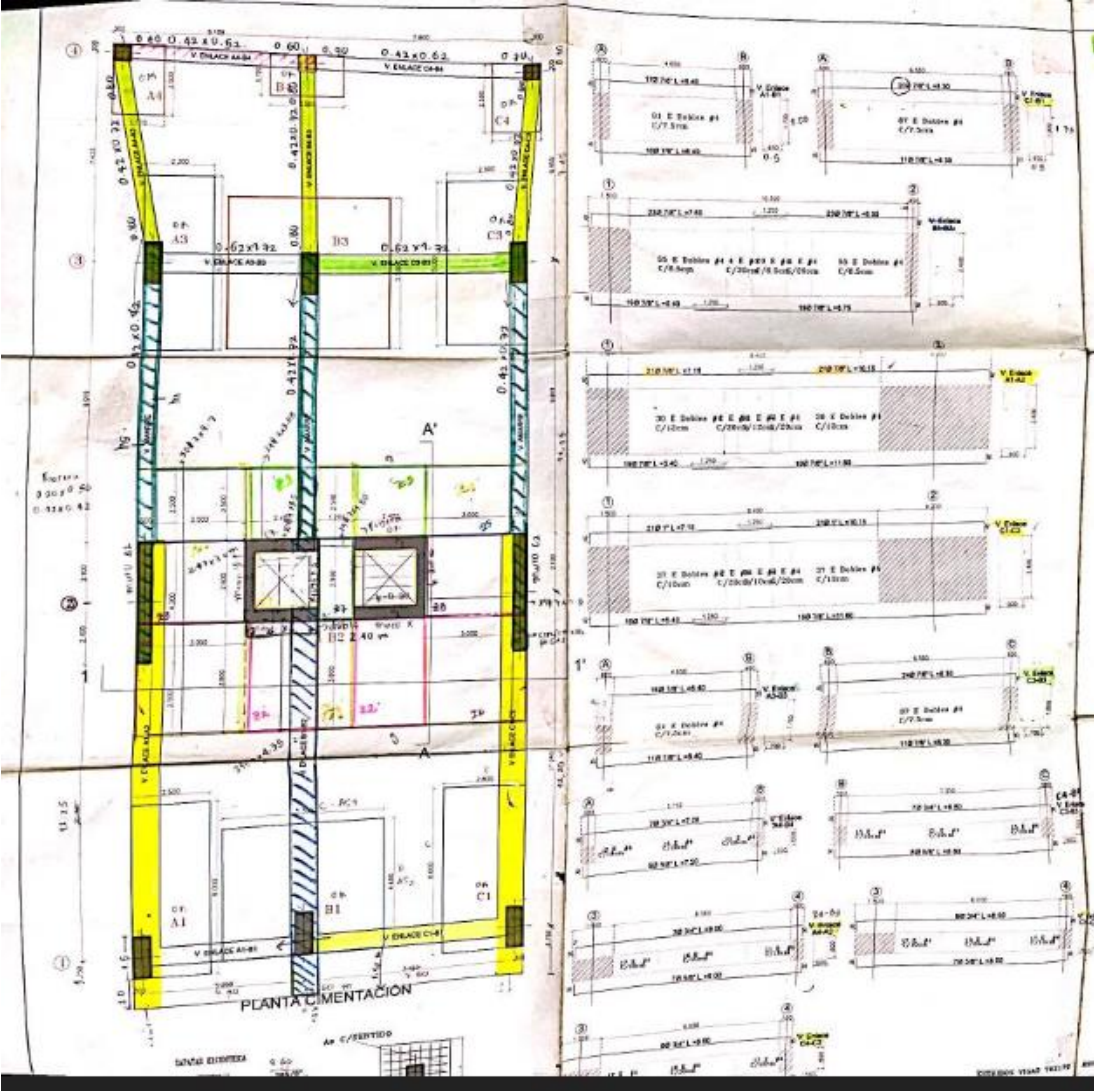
PLANO ESTRUCTURAL CIMENTACIÓN MASERATTI.
